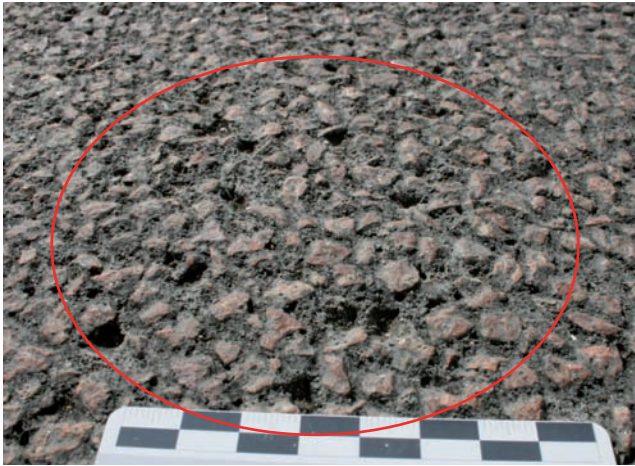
u. 17: Ausgeprägtes und nicht ausgeprägtes Ausbruchverhalten auf Betondecken mit CEM I-Zement
